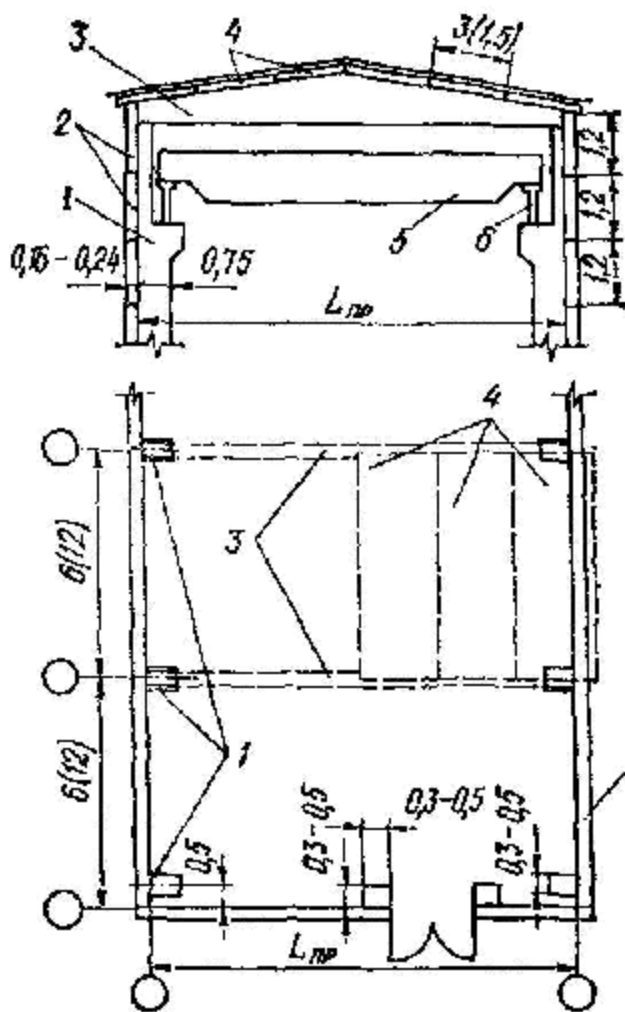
Верхнее строение здания насосной станции каркасной конструкции:
